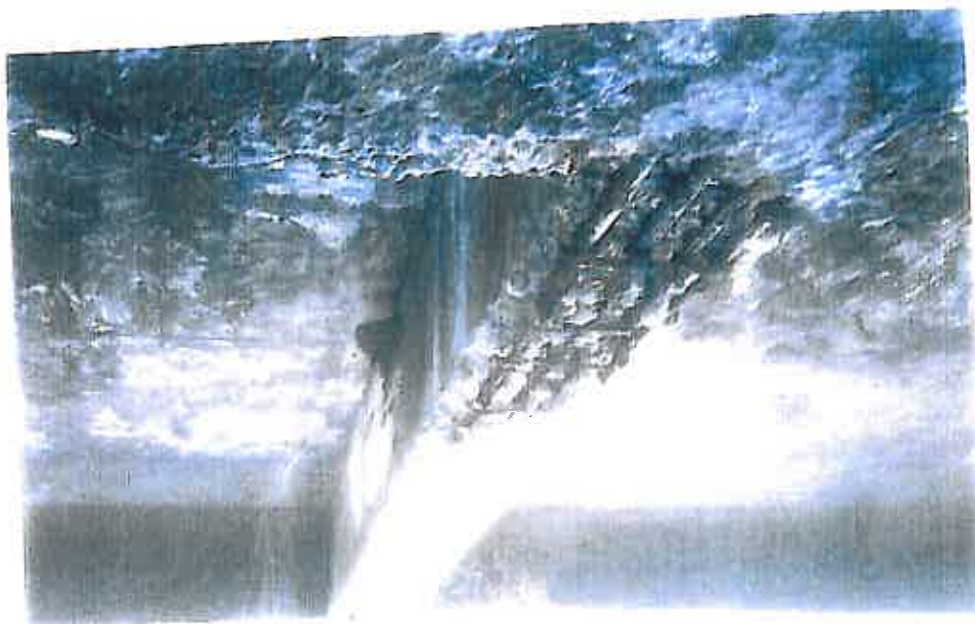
Antretoaza centrala (dupa indepartarea betonului degradat)
